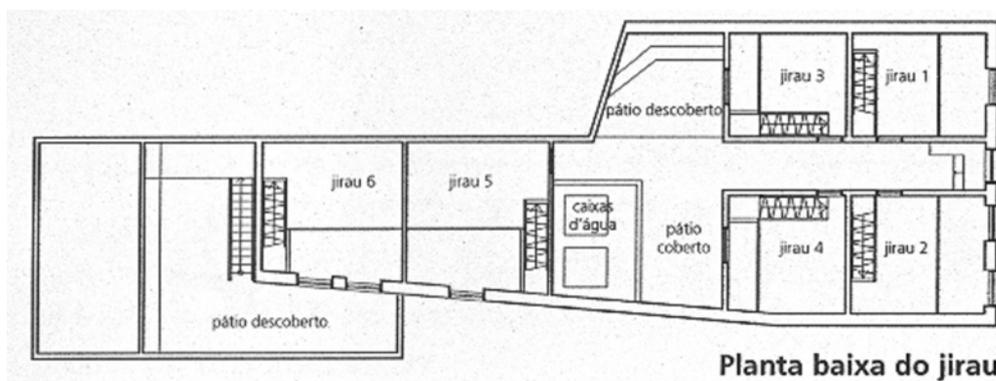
Planta do jirau – sem escala. PREFEITURA, 2003.
